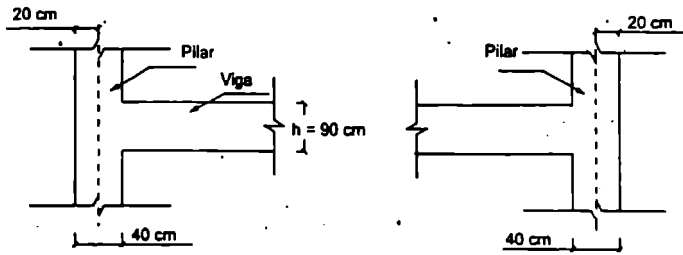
Ligação da viga com os pilares superior e inferior.
